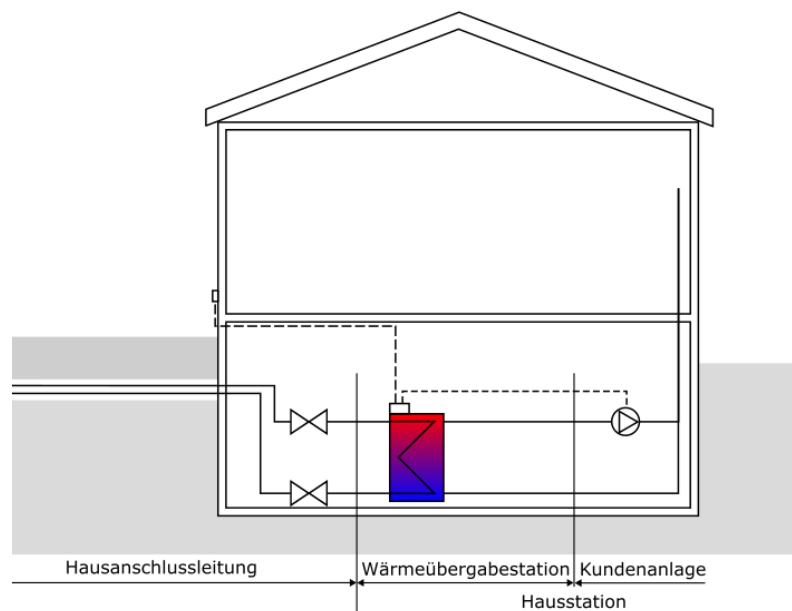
Grenze zwischen Hausanschlussleitung, Wärmeübergabestation und Hausanlage
